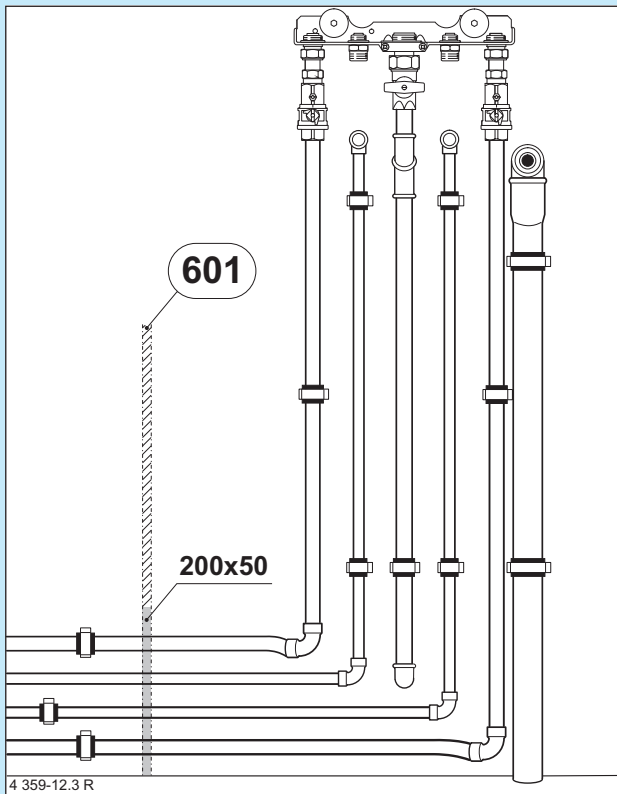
Bauseitige Aufputzverrohrung mit 60 mm Wandabstand
